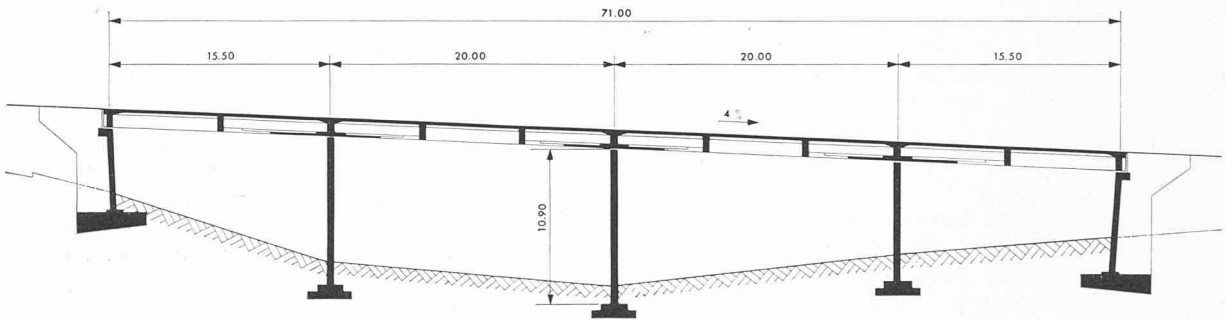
Pont du Cabinet, coupe longitudinale.
